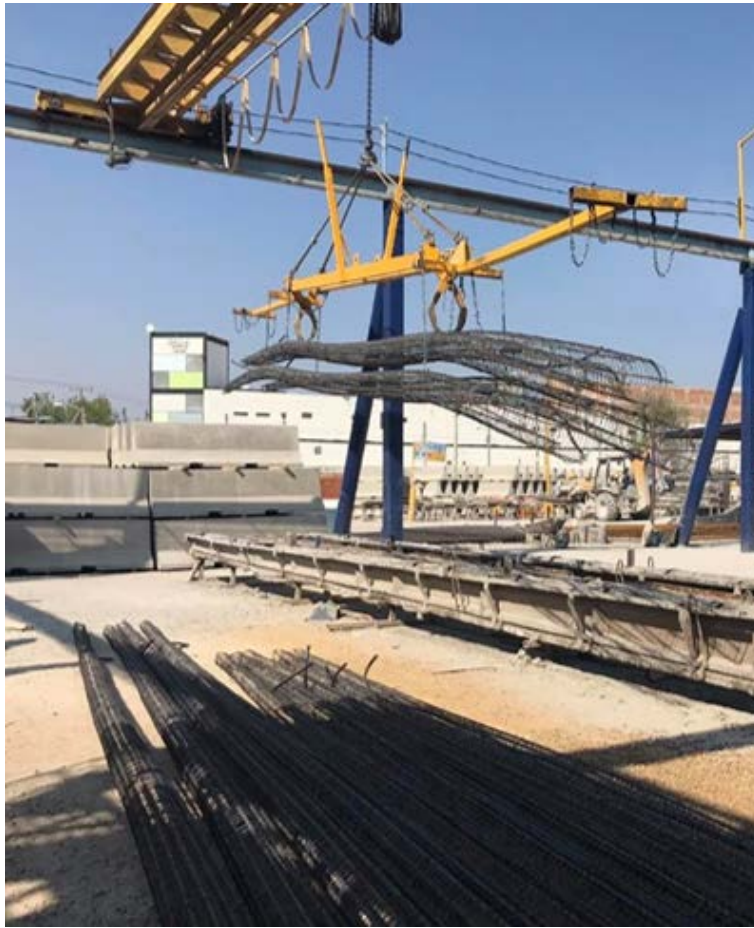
Traslado de armado con ayuda de grúa viajera.
